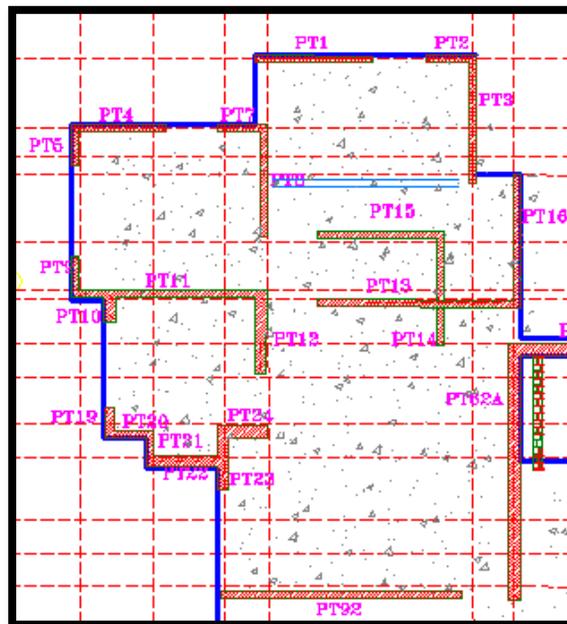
Plano de elementos estructurales, apartamento esquinero.
